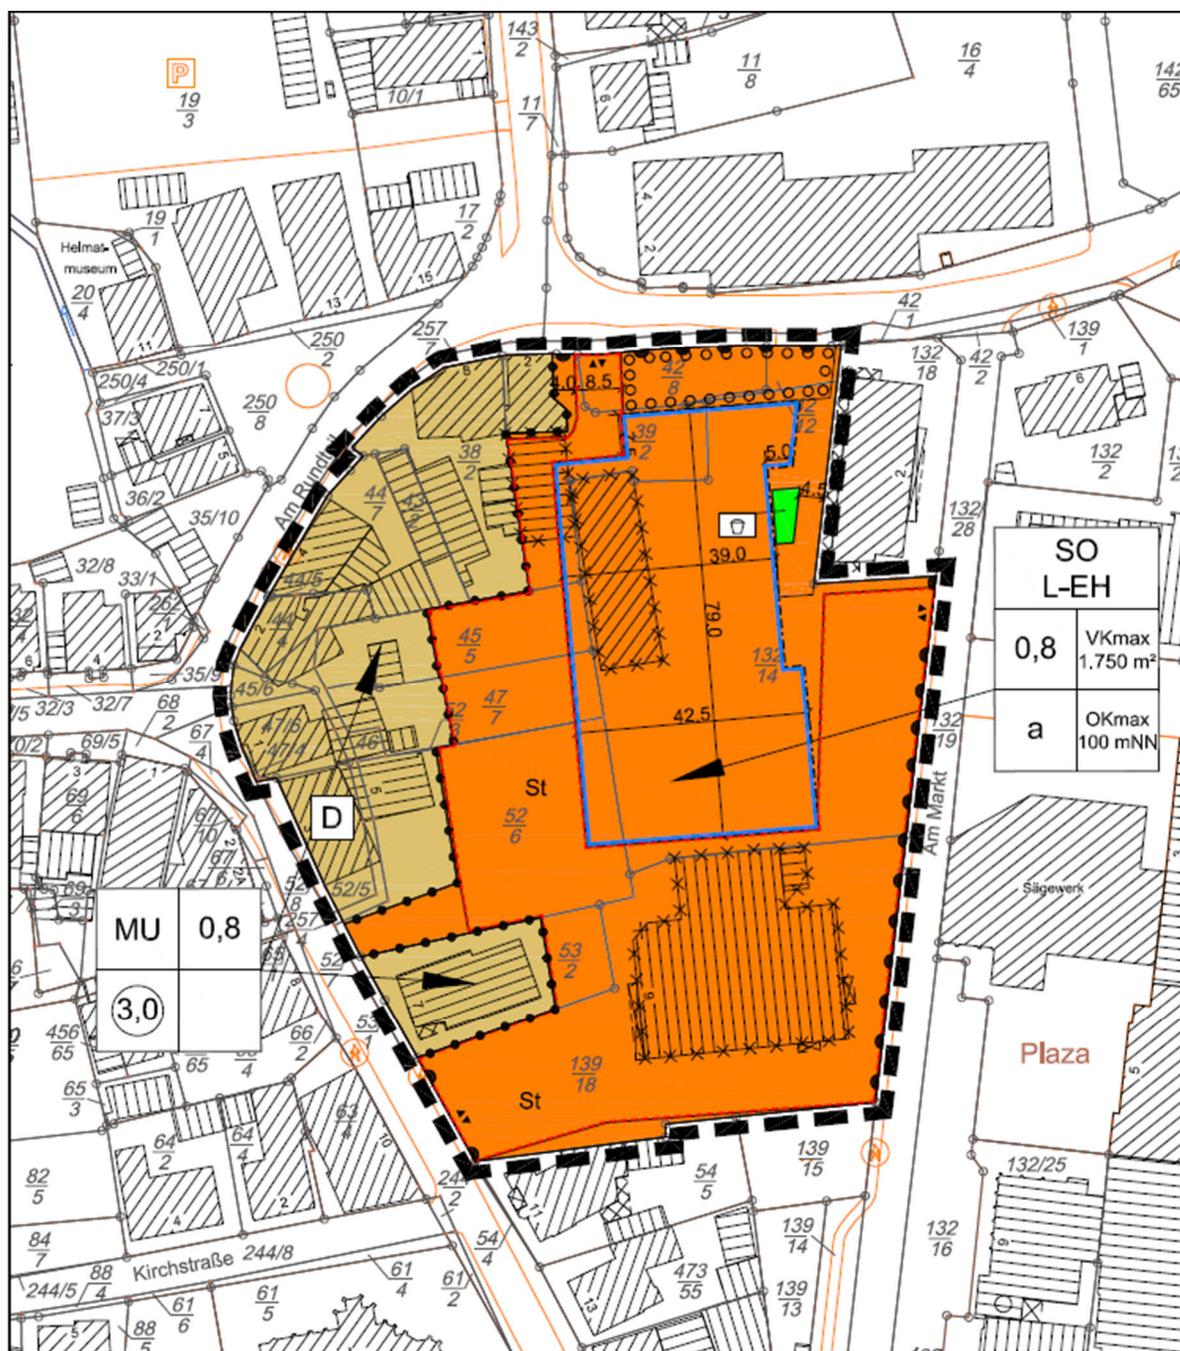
Gestaltungsplan des Bebauungsplans (Quelle: Entwurf des Bebauungsplans Nr. 56 „Am Markt“, Stand 08.07.2021)
